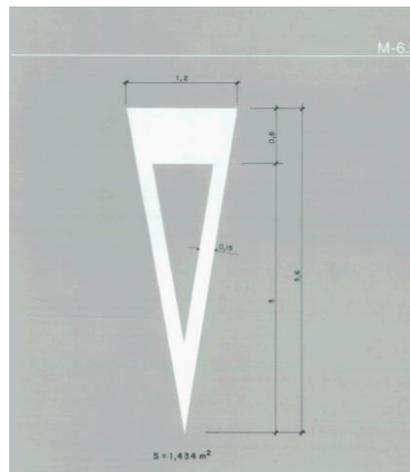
Marca transversal M-6.5 (Fuente: Norma 8.2-IC)
